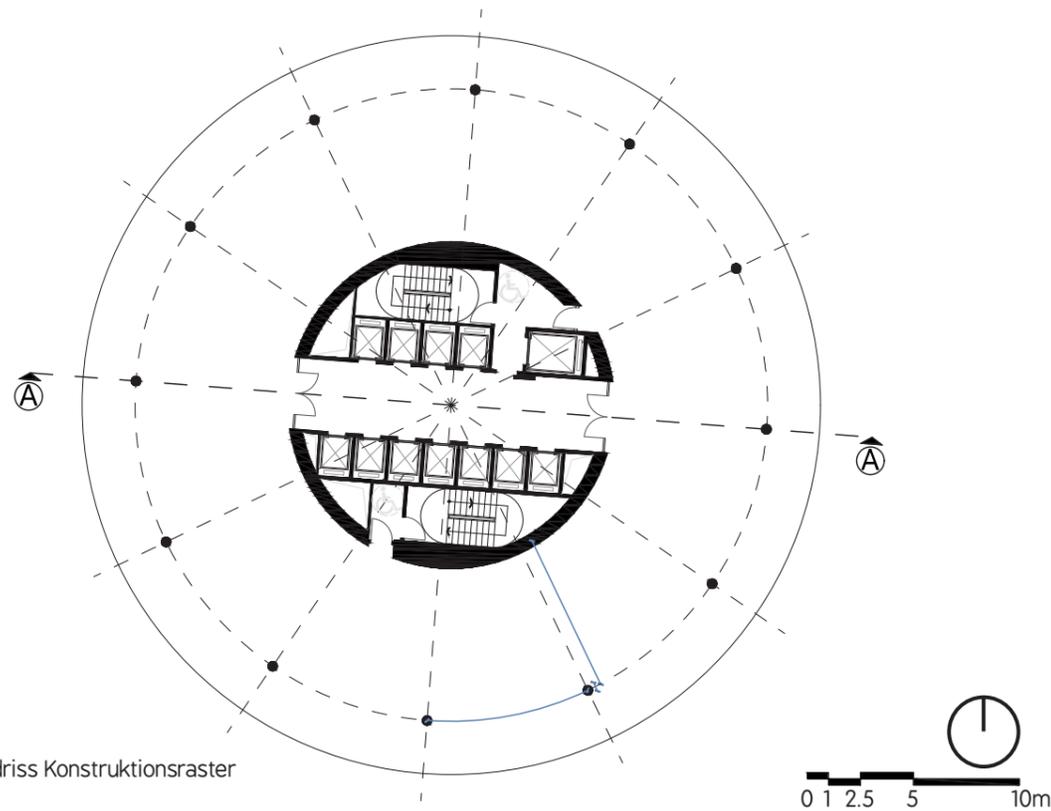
Grundriss Konstruktionsraster (eigener Plan)
